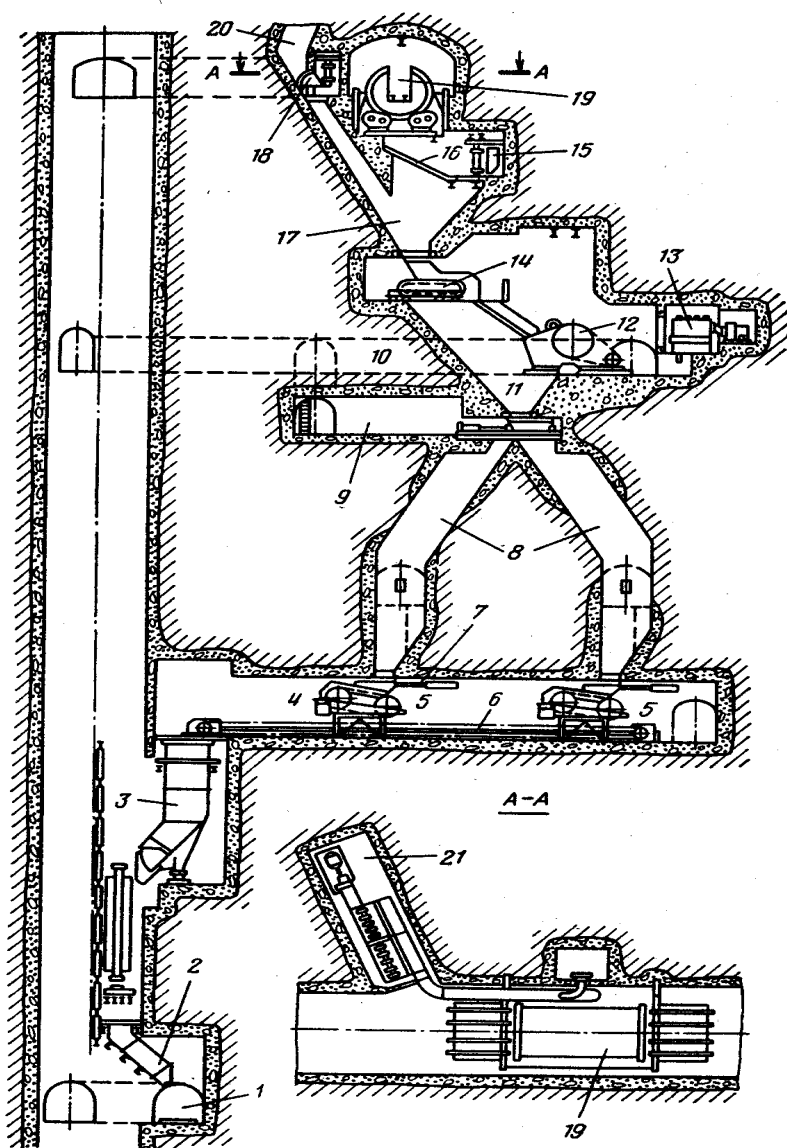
Комплекс камер дробарно-бункерного пристрою для рудників :
